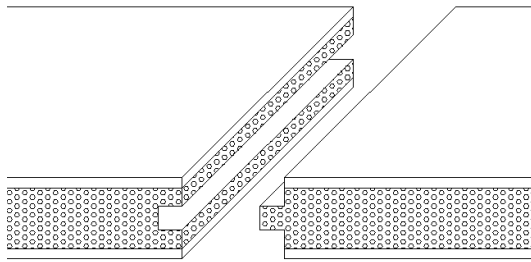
Ligação entre Painéis por encaixe retangular.
